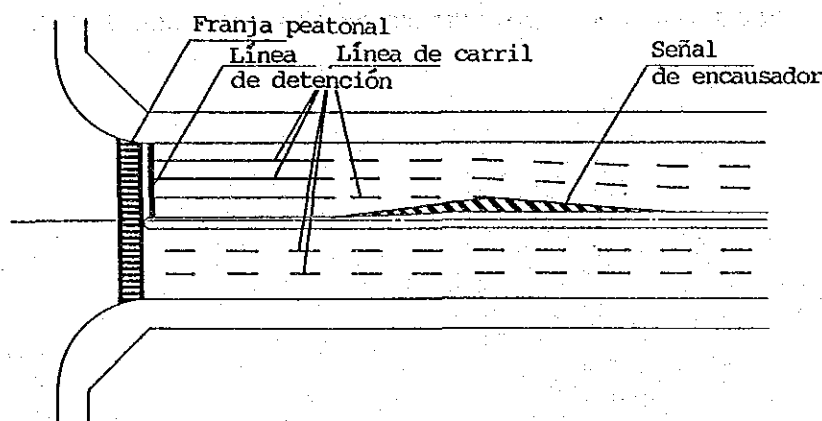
PLANO TÍPICO DE LA SENALIZACION HORIZONTAL
